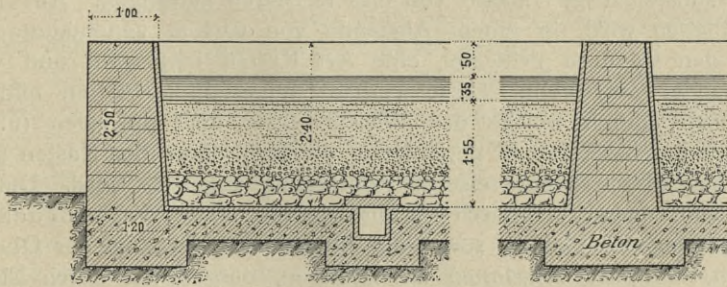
Detail-Längenschnitt durch die Filterbecken.
